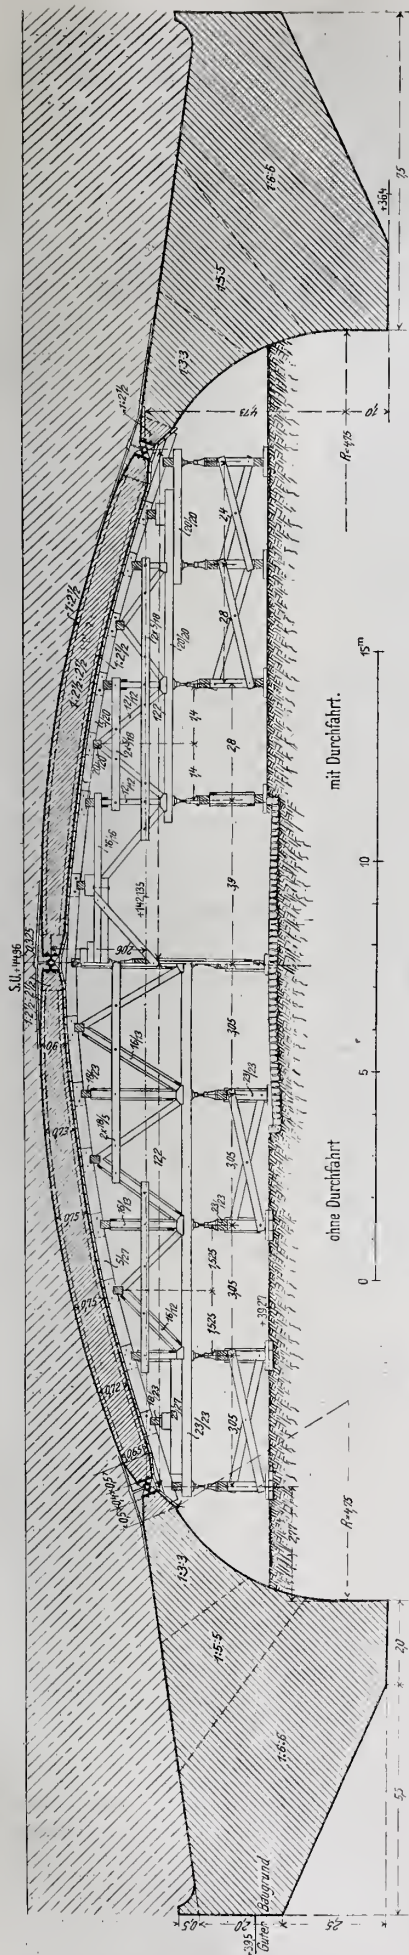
Längsschnitt durch das Brückenbauwerk mit Eintragung der Lehrgerüste.
